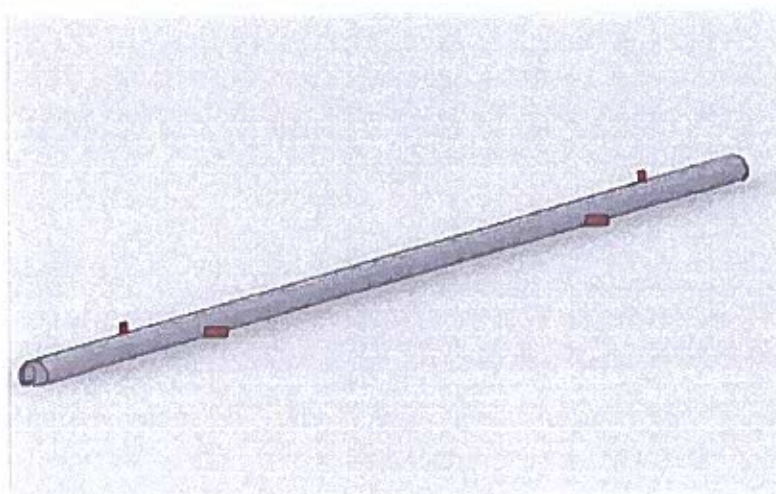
Vista prospettica della stazione senza allargamento di sezione (Europa); in rosso sono rappresentati i pozzi di ventilazione e parte dei corridoi di collegamento con l’altro fornice ed i passaggi interni della stazione.
